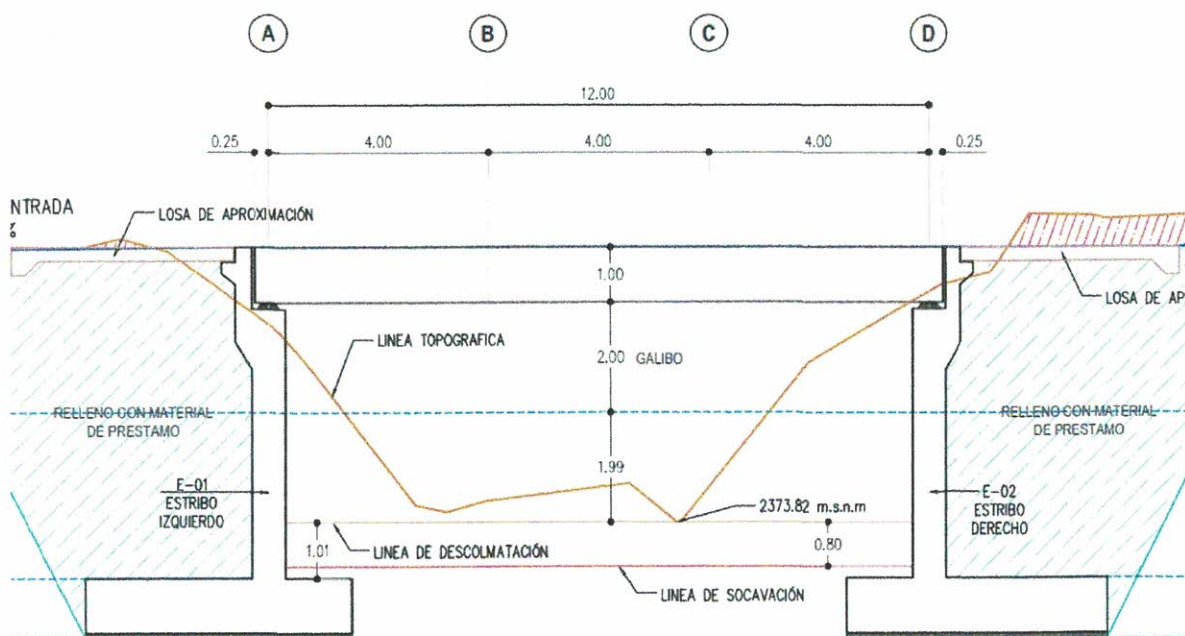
Vista en elevación longitudinal del Puente el Remolino
